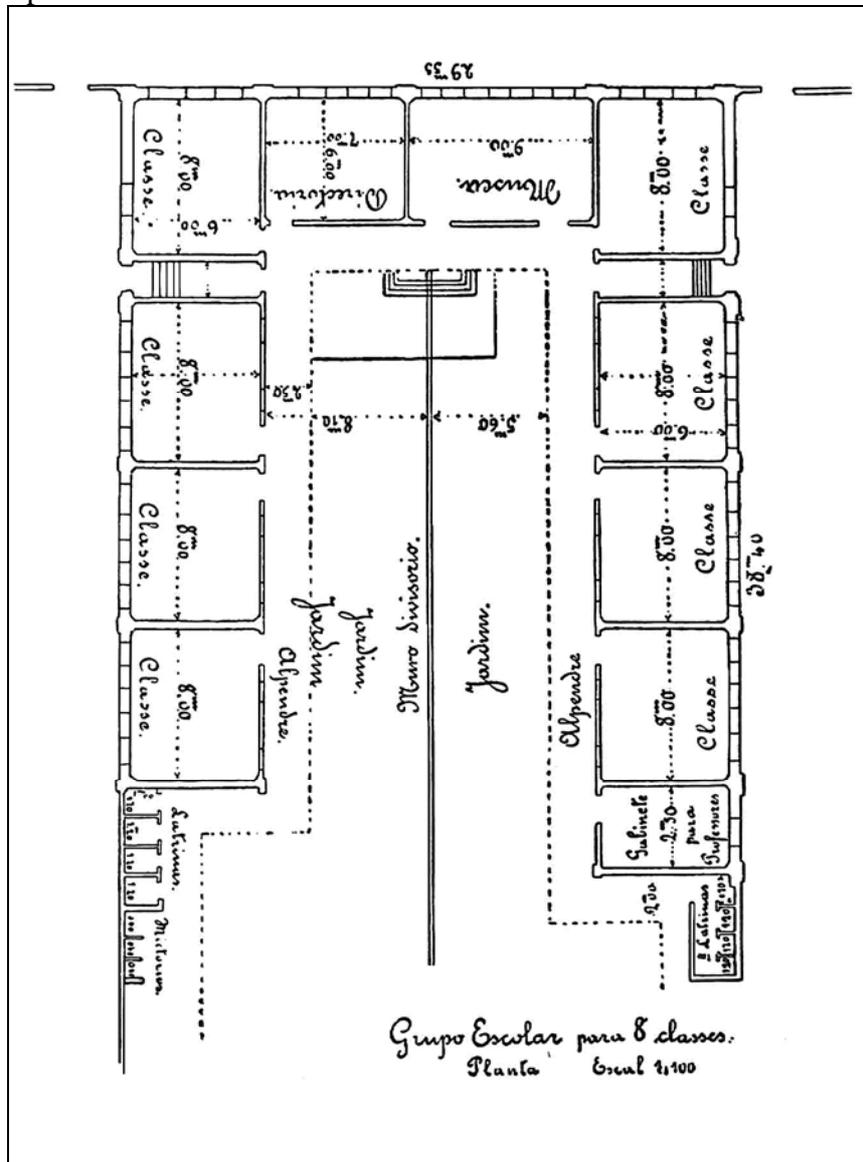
Planta-tipo da fachada de um grupo escolar com oito salas elaborada na Secretaria de Viação e Obras Públicas de MG
